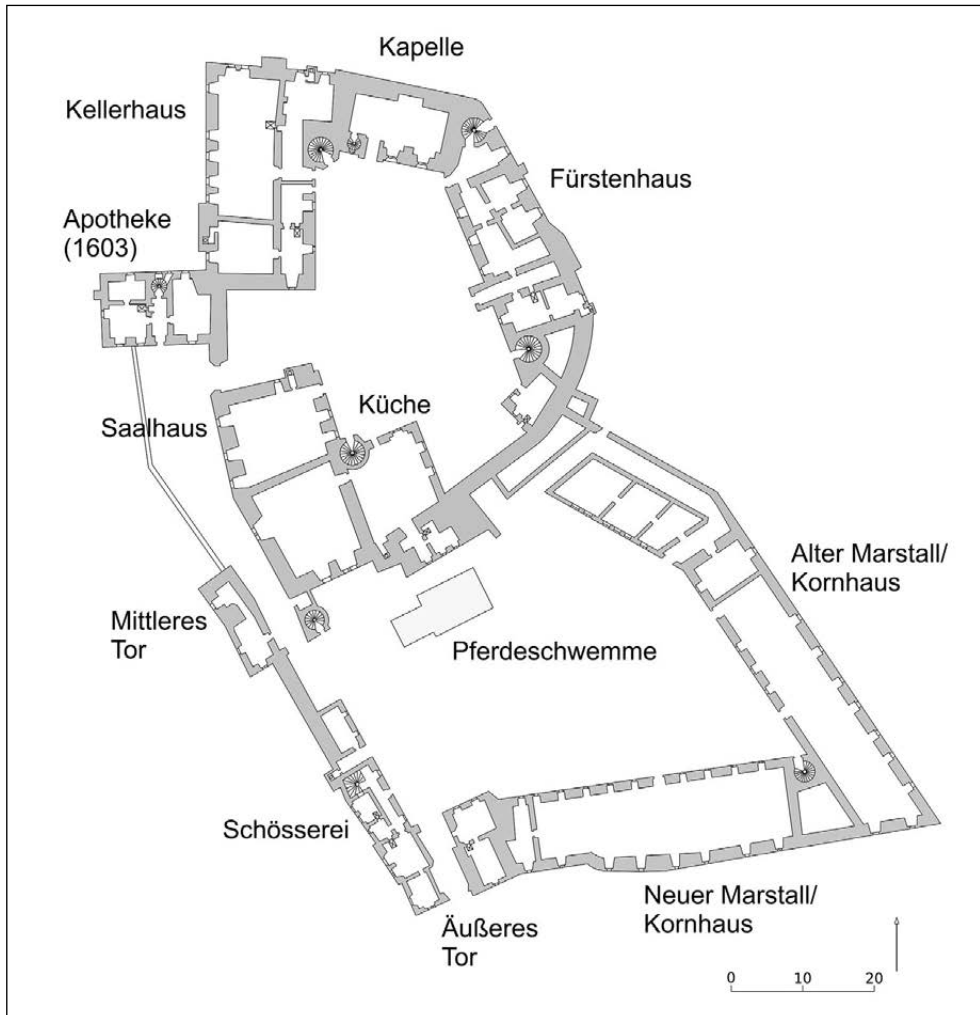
Colditz, Schloss Colditz, Erdgeschoss, Grundriss, Zustand im 18. Jahrhundert
